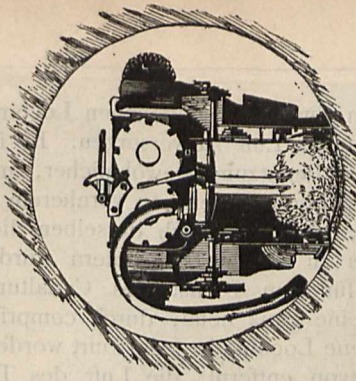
Rückansicht der Bohrmaschine. Links der Schlauch zur Zuführung der Pressluft.
